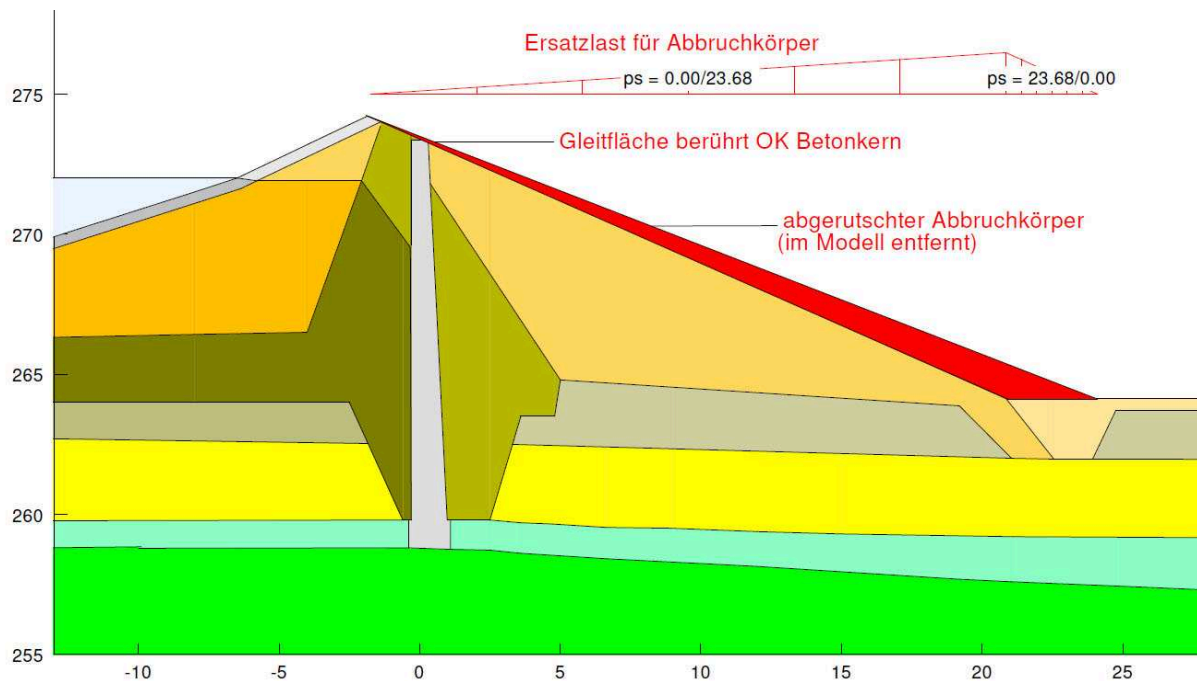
TS Auma, Lastfall Bemessungserdbeben, Restkörper mit Auflast in der Belastungssituation 3
